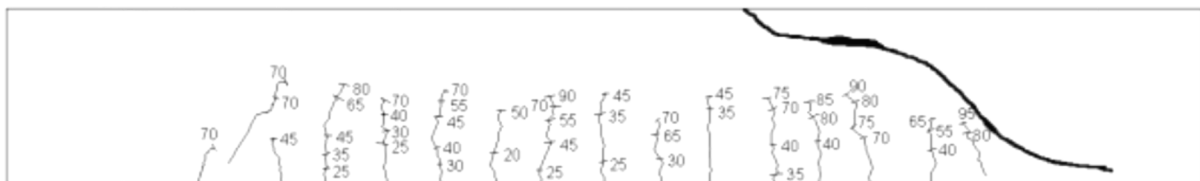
Mapa de fissuras da Viga V5A100
